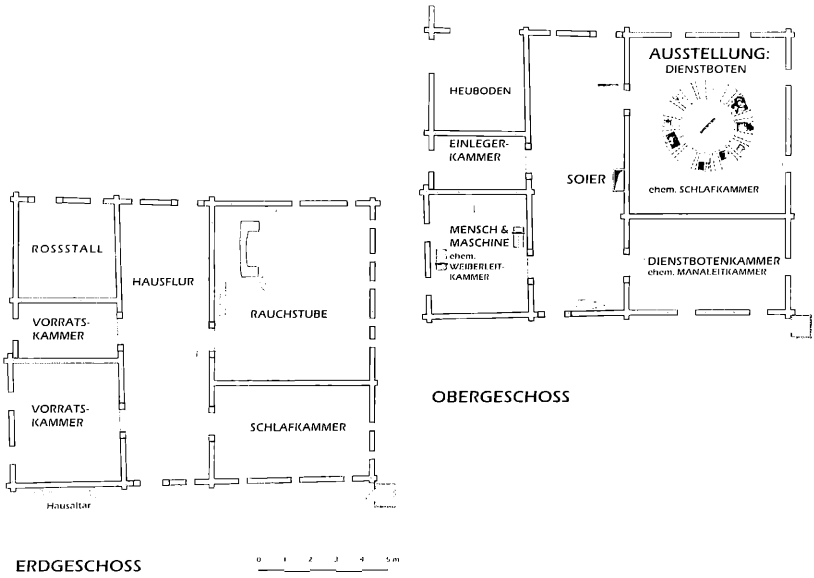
Grundriss des Taxbauernhofes.
